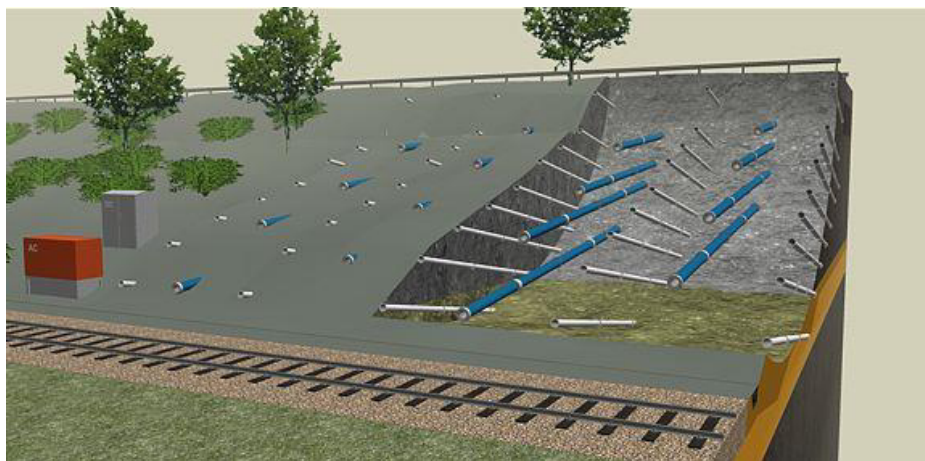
Projeto de instalação de um sistema de drenagem num talude. Retirado de <http://www.electrokinetic.co.uk/soilnails.htm>.
